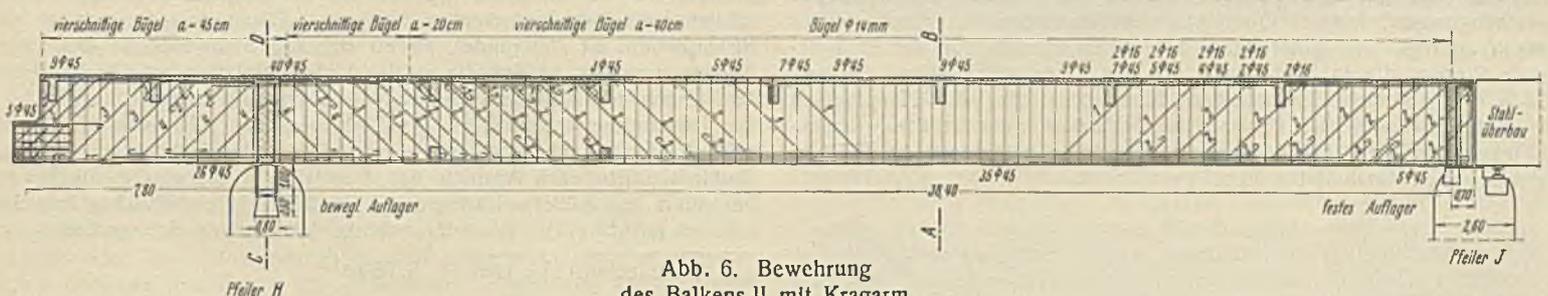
Bewehrung des Balkens II mit Kragarm.
